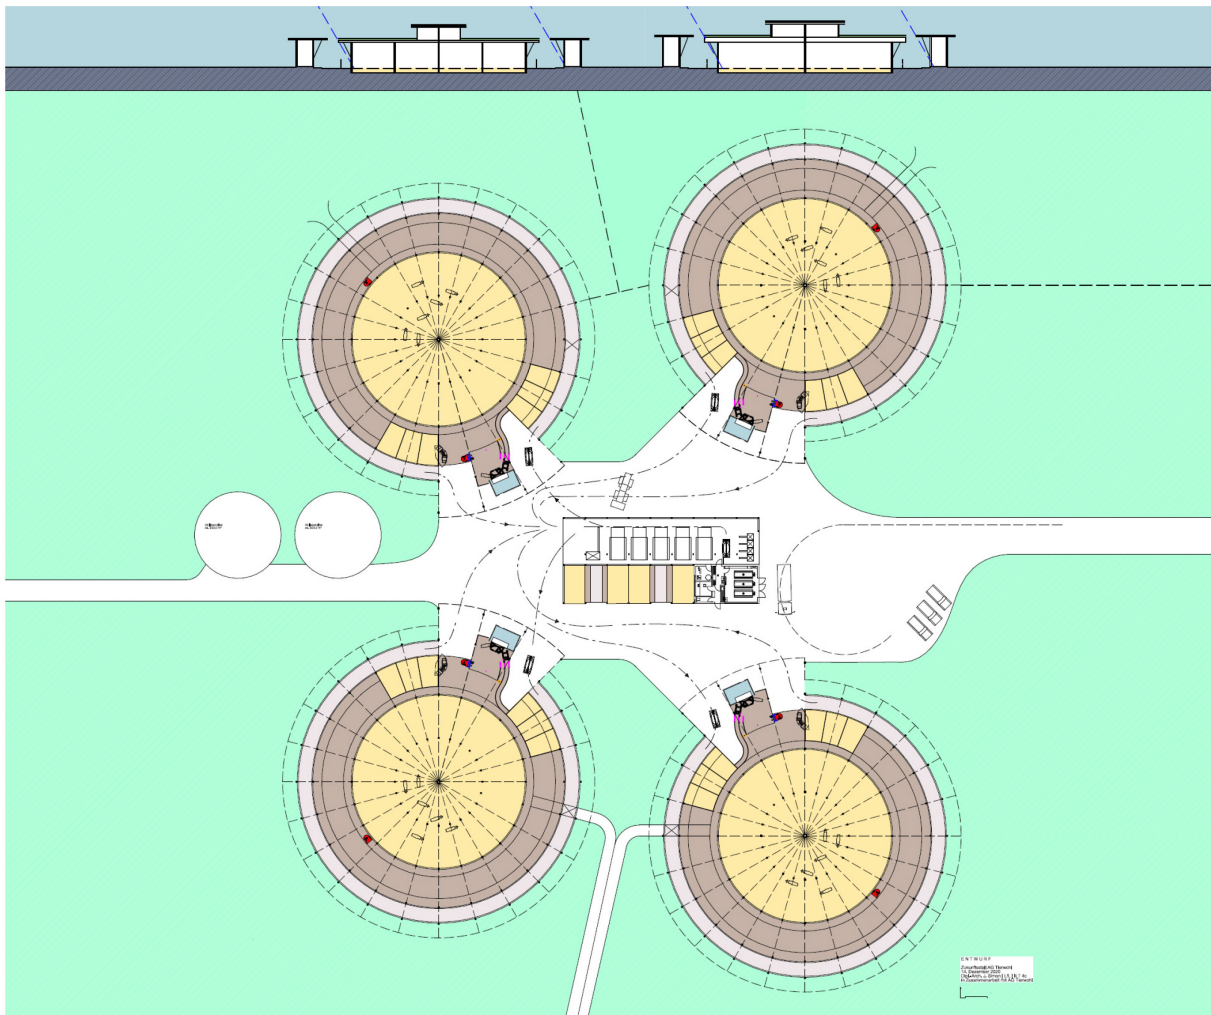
Grundriss und Schnitt des Tierwohlstalles
